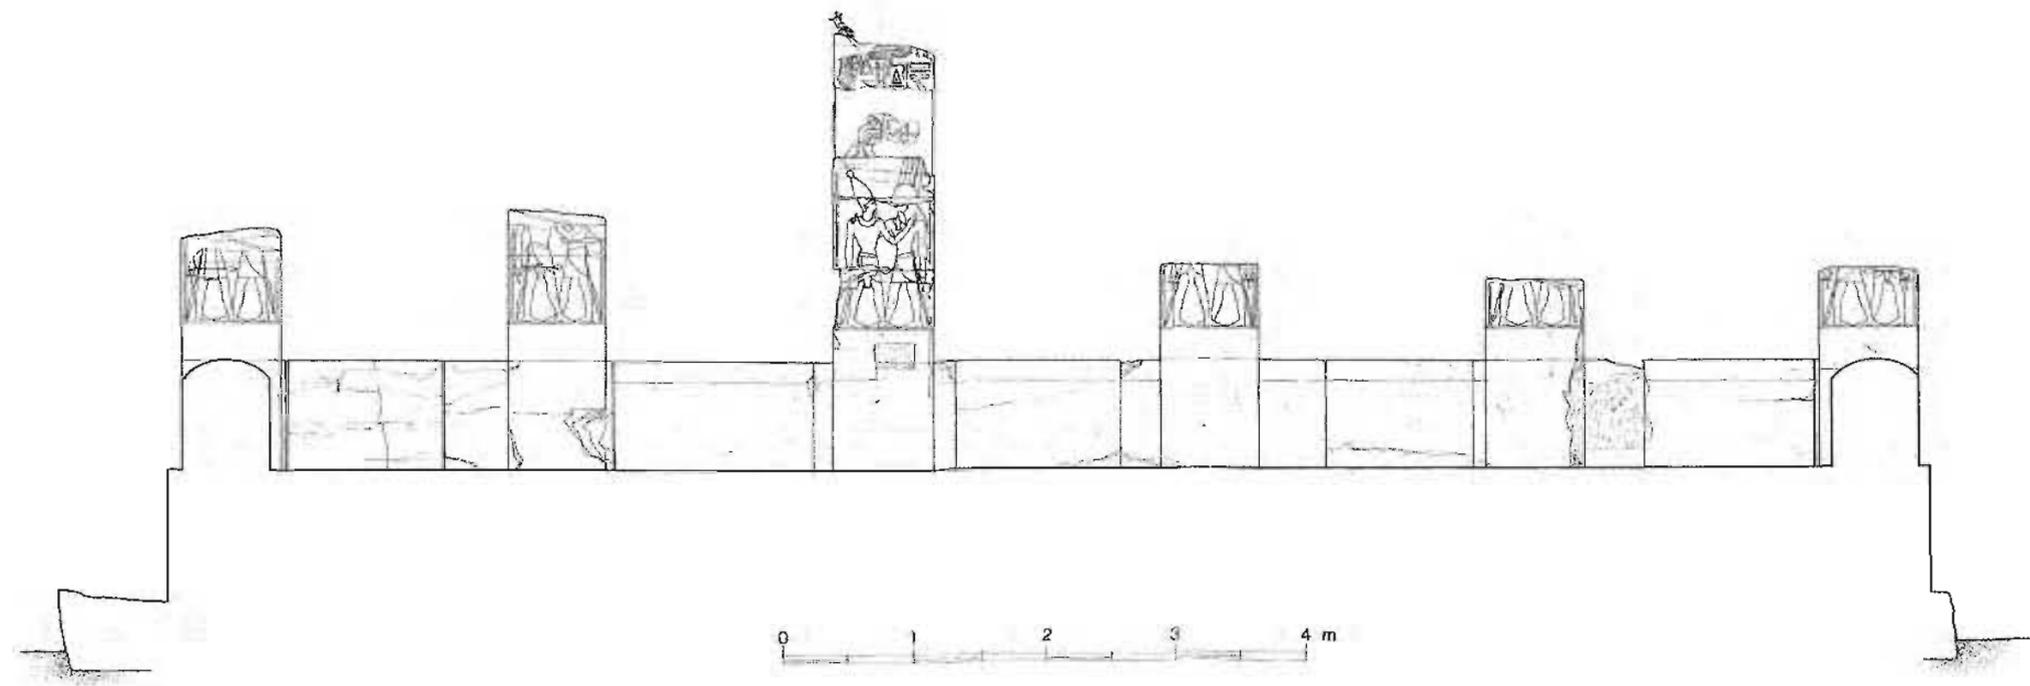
Coupe sur la galerie est vers l'est, MM'
